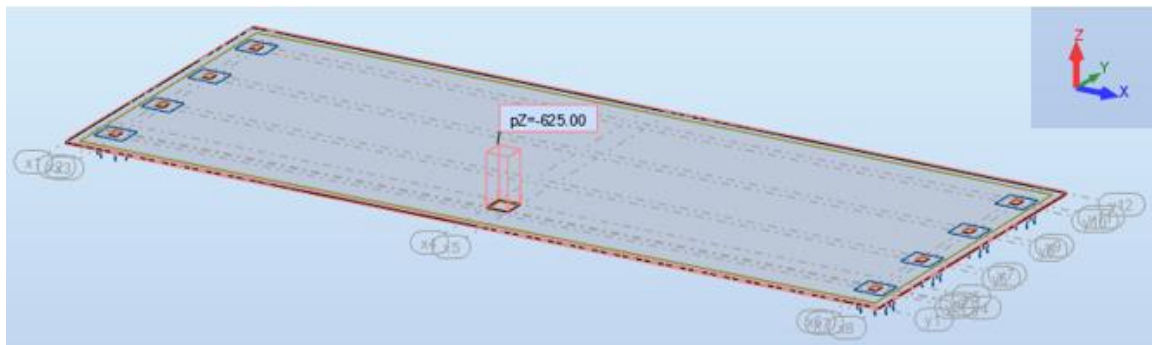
Desenvolvimento de modelo de laje de elementos planos com apoios planos: representação esquemática (Robot)
